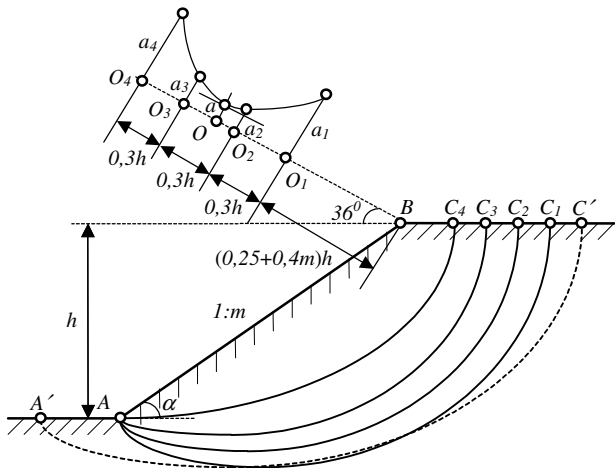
Схема до визначення центру обертання найбільш небезпечної круглоциліндричної поверхні ковзання
